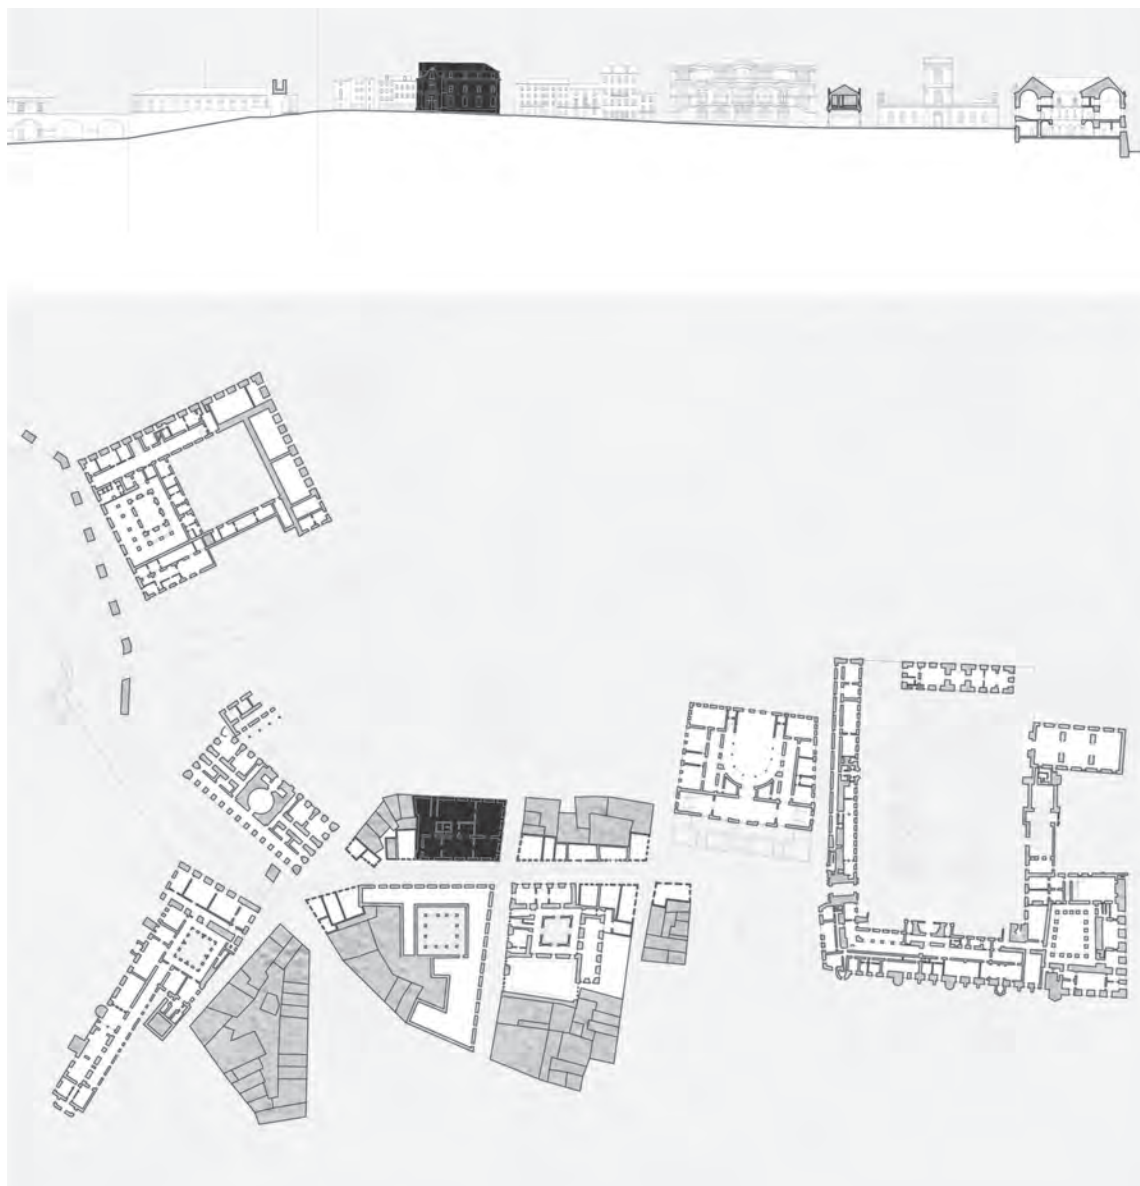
e 11 - Perfil e Planta de localização do Colégio de São Paulo, o Eremita
